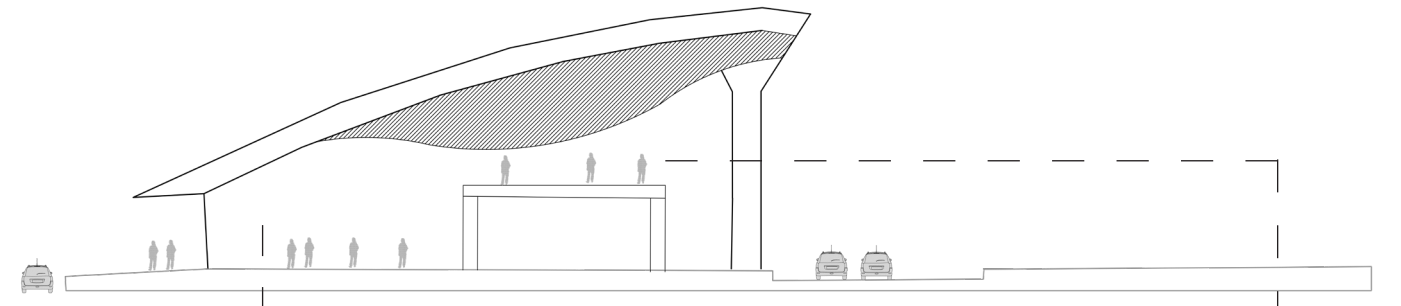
Corte transversal B-B' esquemático, nexo articulador | ESCALA 1:500 | Fuente: Elaboración propia (2023).
